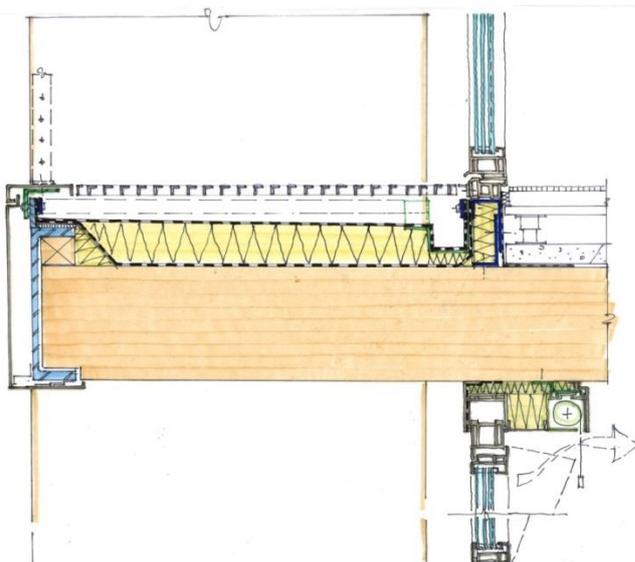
Darstellung der Holzdecke anhand eines Details
